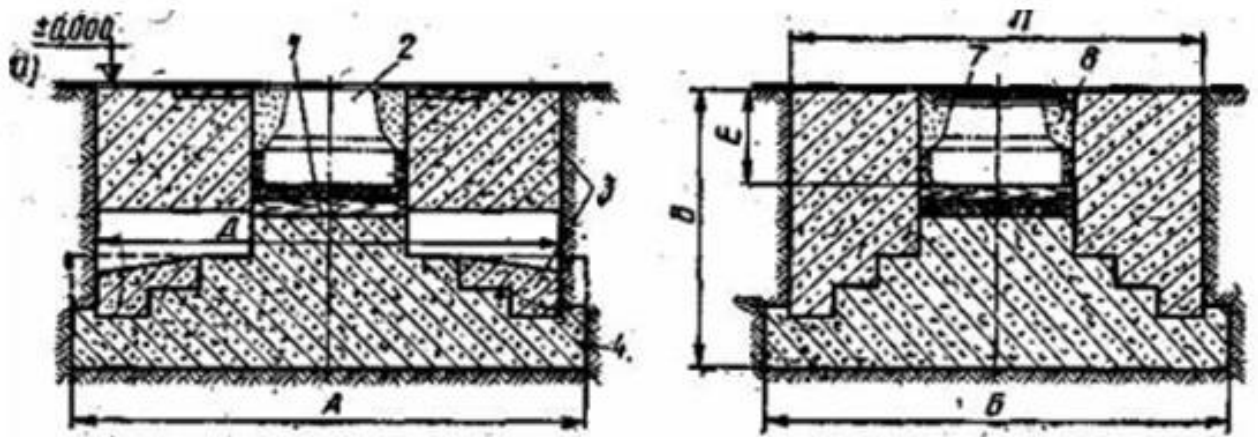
Схемы фундаментов под паровоздушные ковочные молоты[13]:
